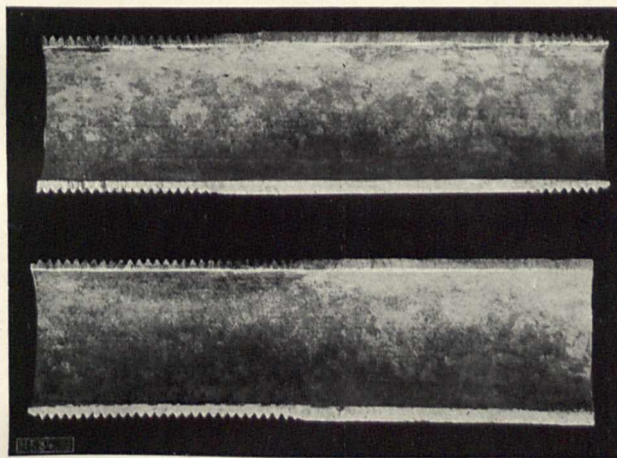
Rohrabchnitt aus einer Aachener Warmwasserversorgung nach vierjährigem Betriebe mit Desoxygenbehandlung
